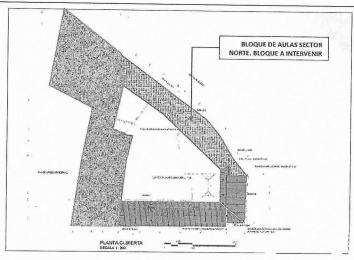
Planta general de cubierta. Fuente: Archivo personal.
